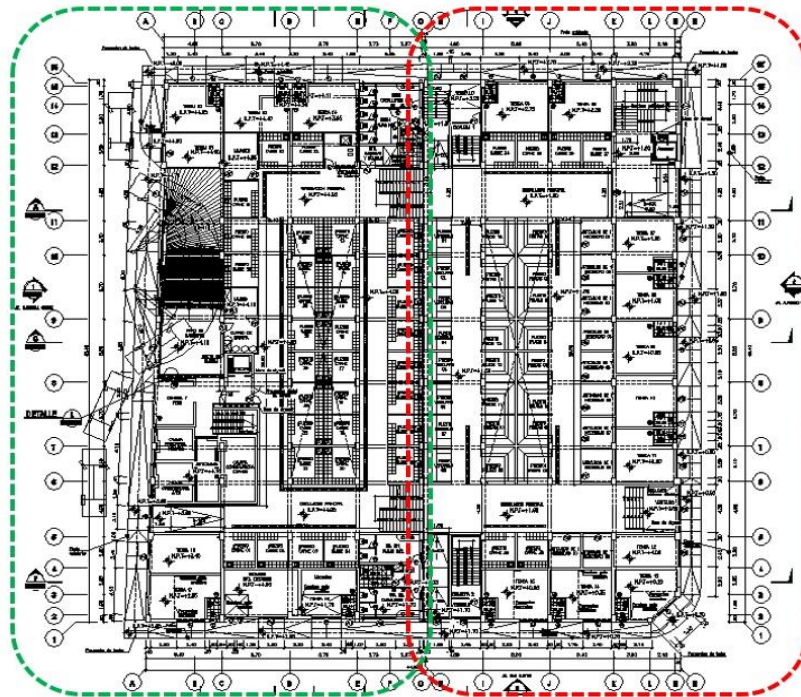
Planta de distribución, Bloque A (lado izquierdo) y Bloque B (lado derecho).
